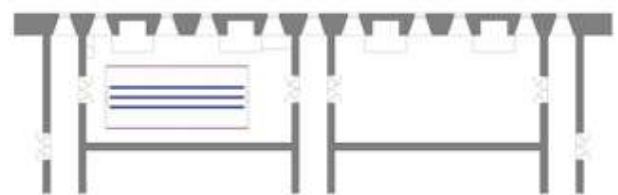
Planta da reserva e sala contígua. @Mário Lopes
